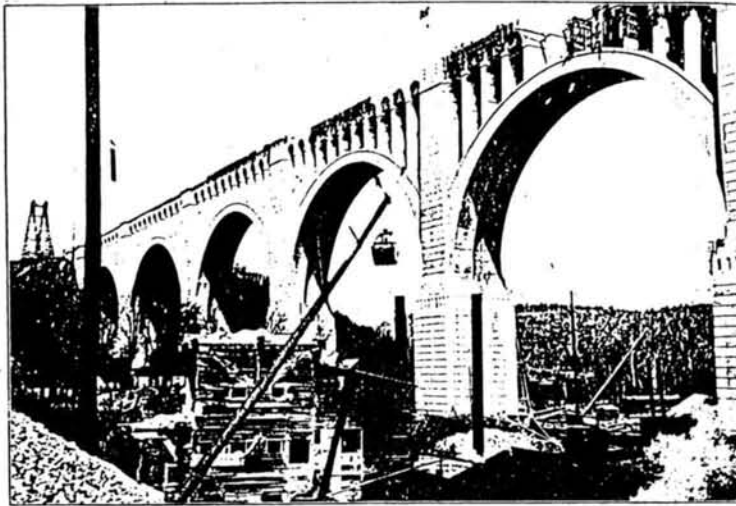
Tunkhanock Creek Bridge 施工中の米国鉄筋混凝土拱橋<sup>19)</sup>
